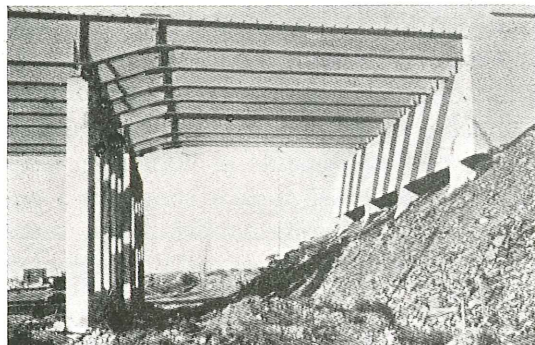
Aspecto de la junta metálica del puente de la figura anterior antes del desbloqueo.
